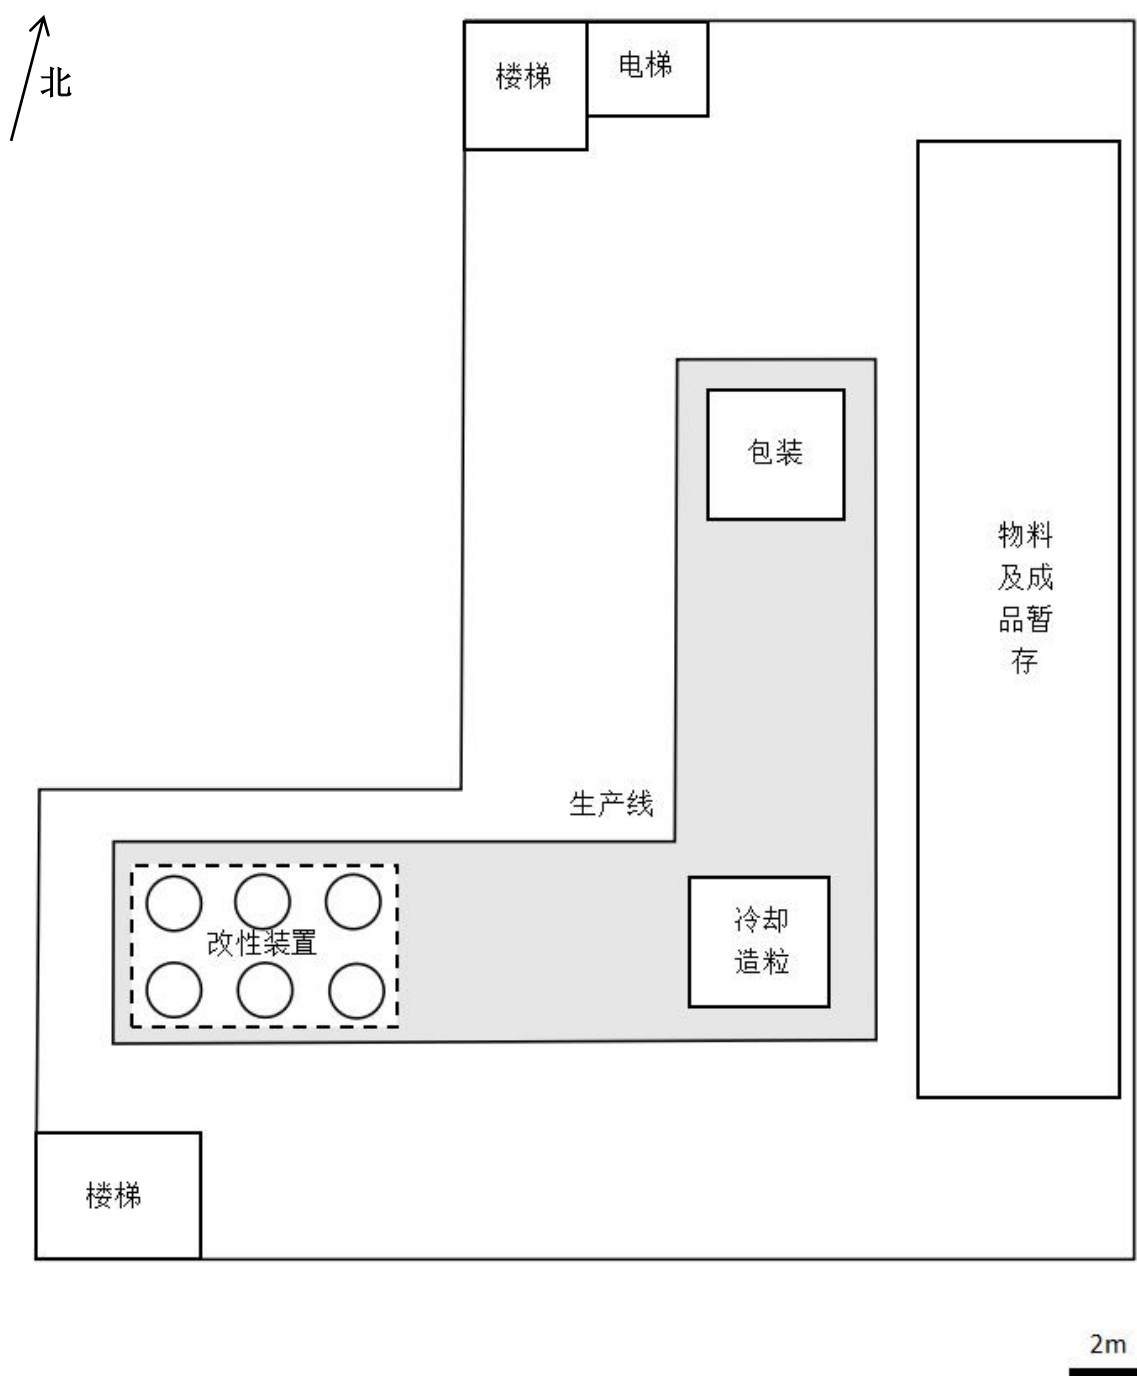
1、2F 丙类厂房布置图（3、4F 相同）
